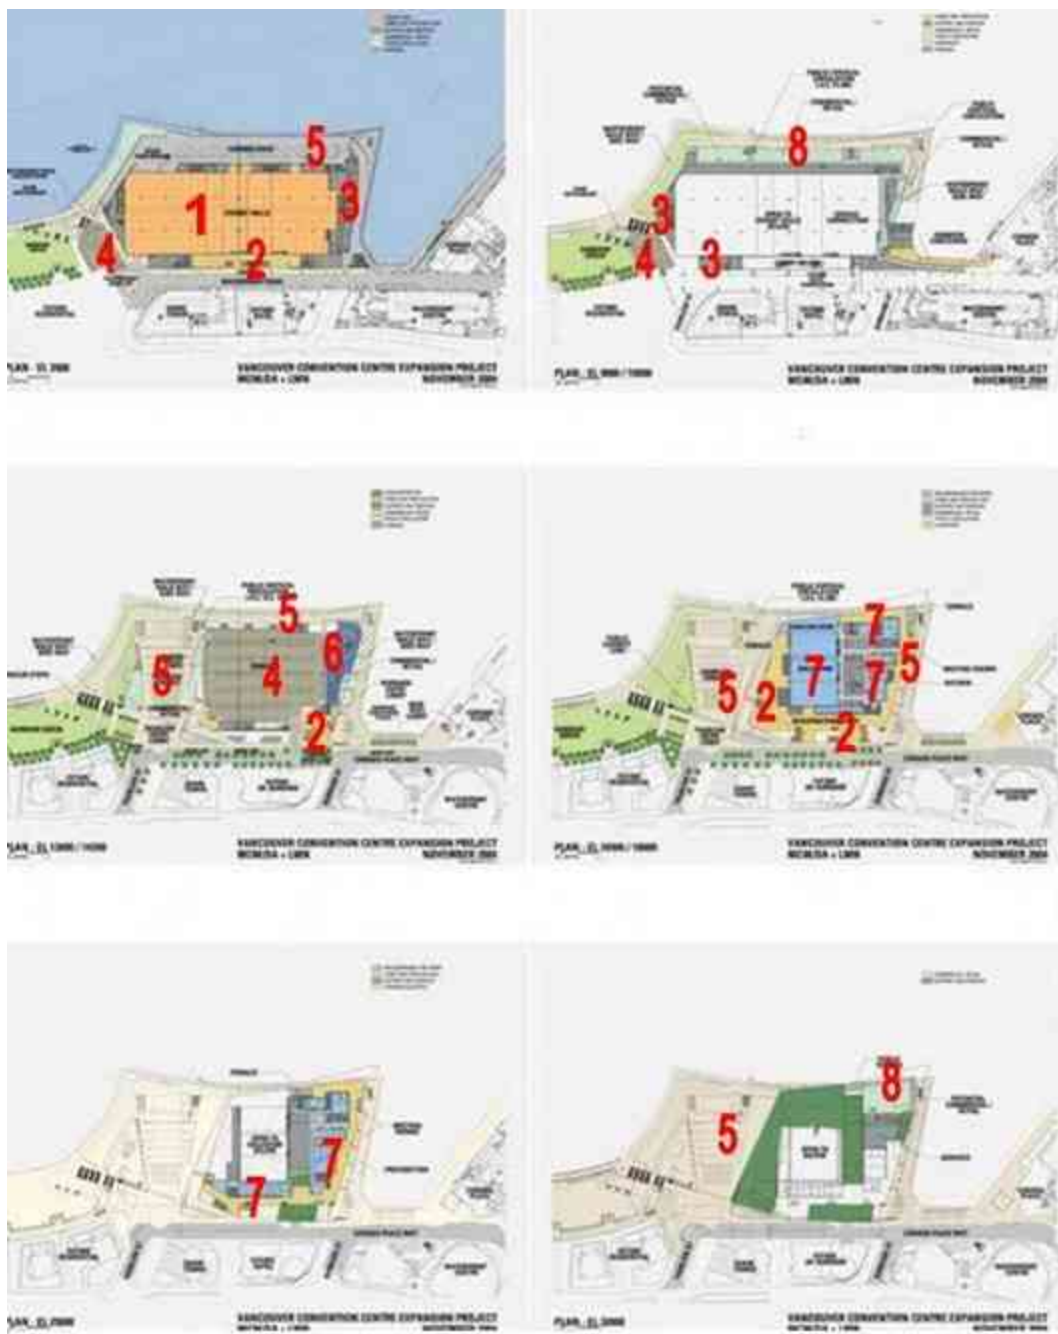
Programa Arquitectónico. Foto LMN / Studio. (<http://www.archdaily.com/130373>).
